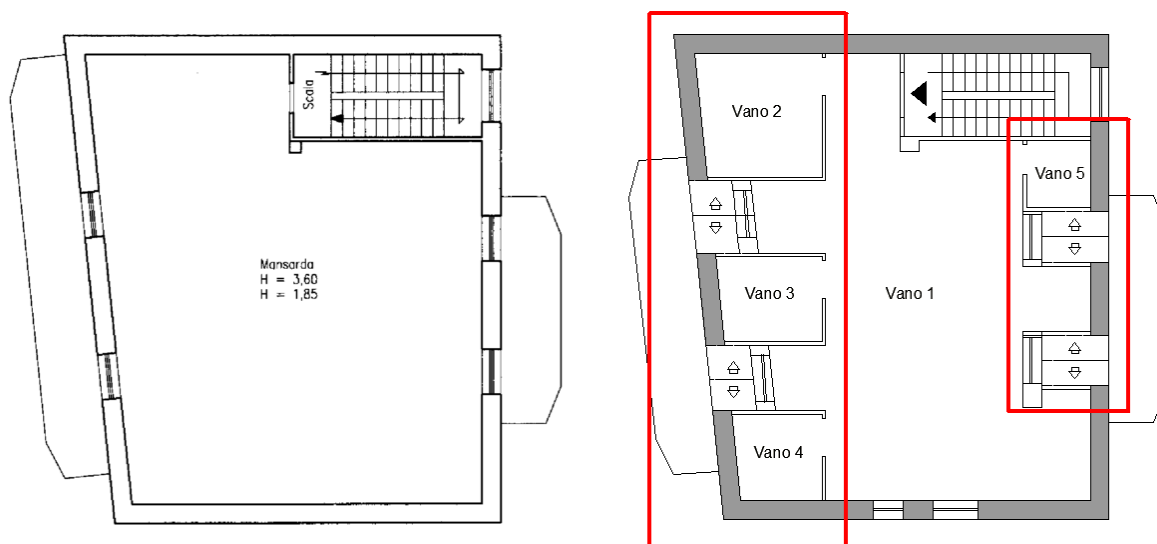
Confronto planimetria catastale e stato reale dei luoghi – piano primo (sub.4)
